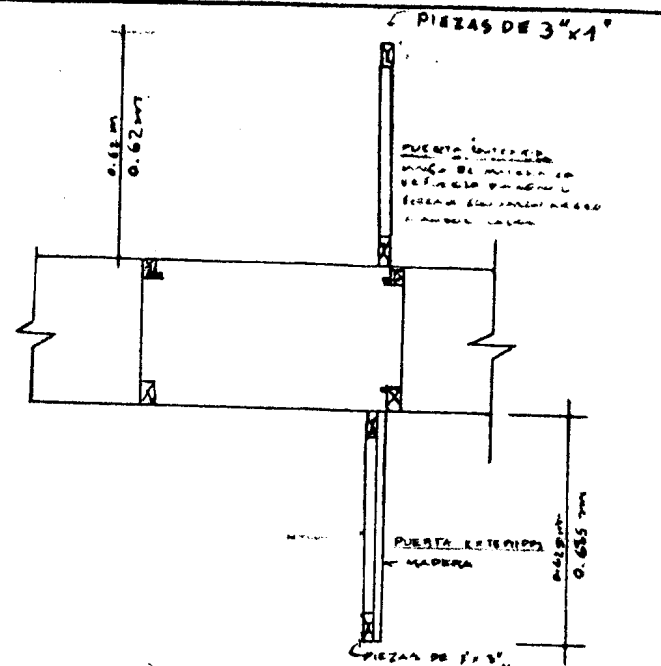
Detalle en planta de ventanas, puerta y vigas.
